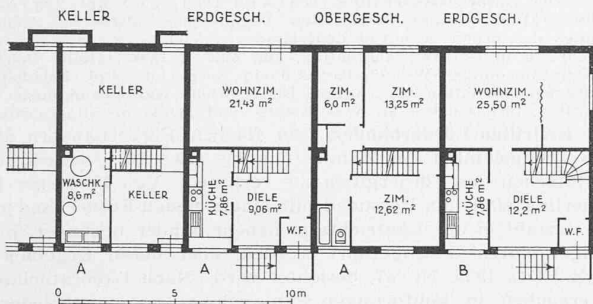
Gruppe D der Baugenossenschaft Theresiengarten. Grundrisse 1 : 300. A Eingebautes Einfamilienhaus, B Eckbau. Architekt Walter Bosshart, Zürich.
